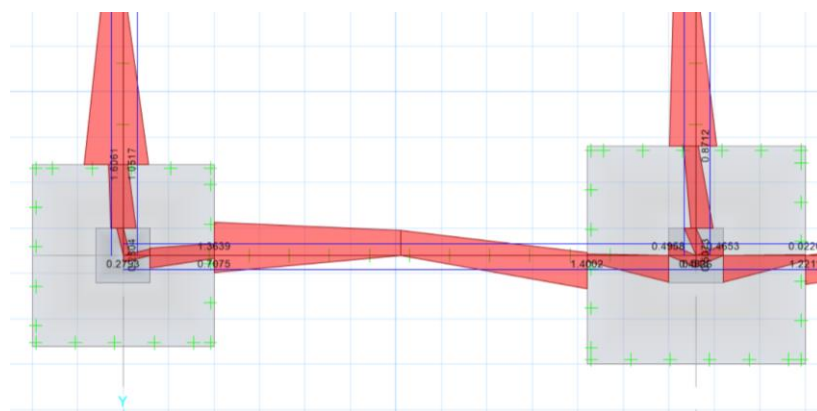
Acero de refuerzo longitudinal de cadena más cargada
